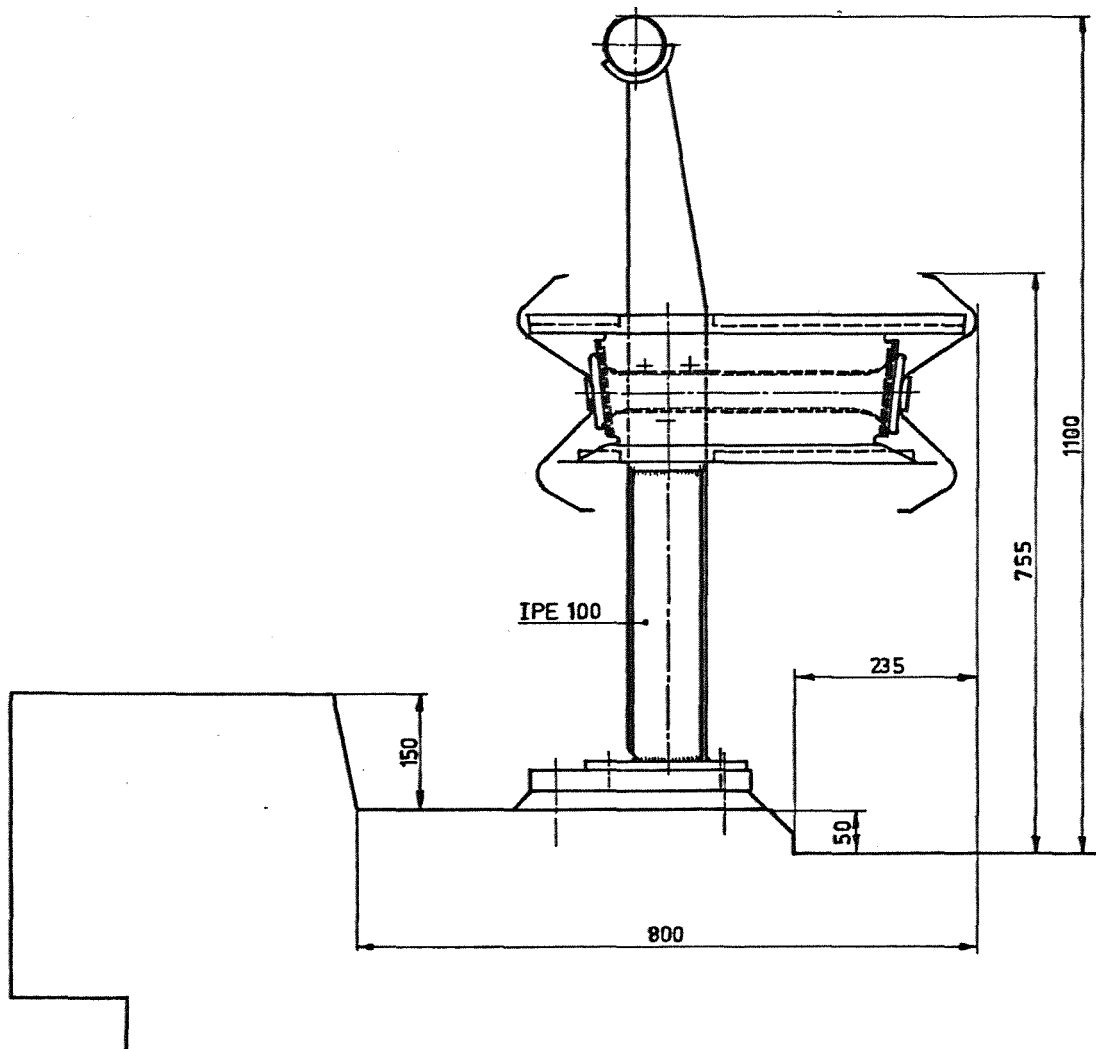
Globaal te verwachten uitbuigingen van de beveiligingsconstructies.
